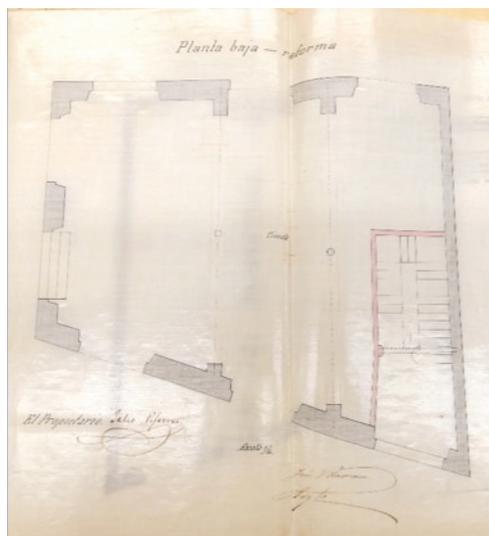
Josep Vilaseca, Reforma de la planta baixa de la casa de Felio Piferrer, AMCB, 1883
